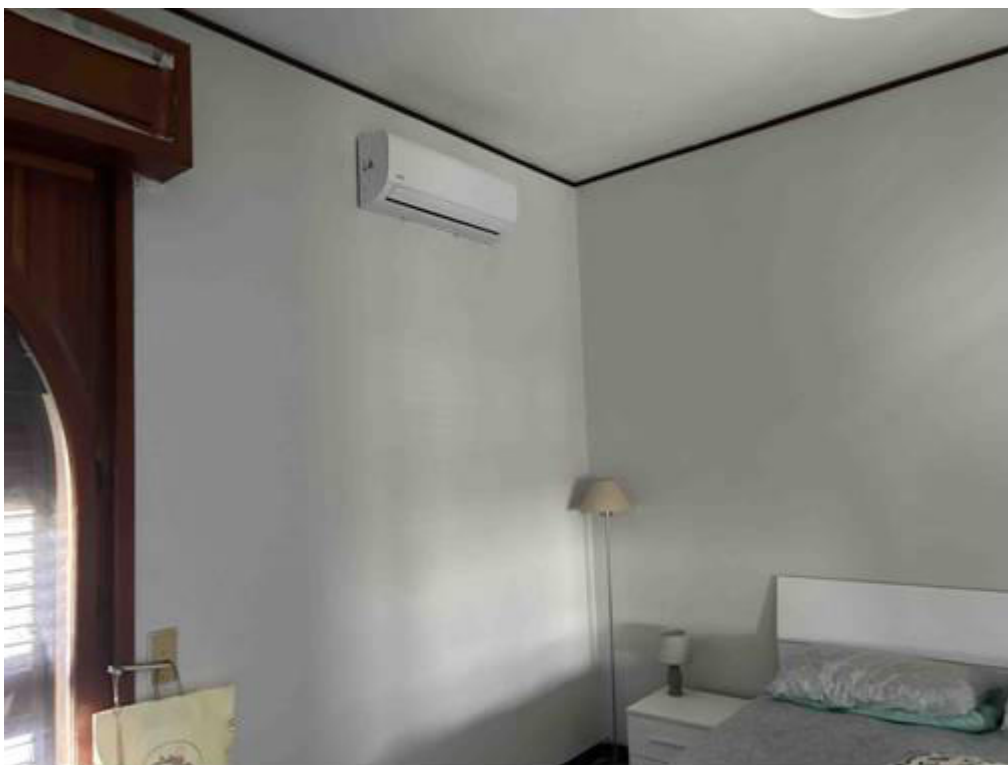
Foto scattata in una delle camere da letto. Le pareti sono rifinite con intonaco civile e tinteggiate con idropittura.
